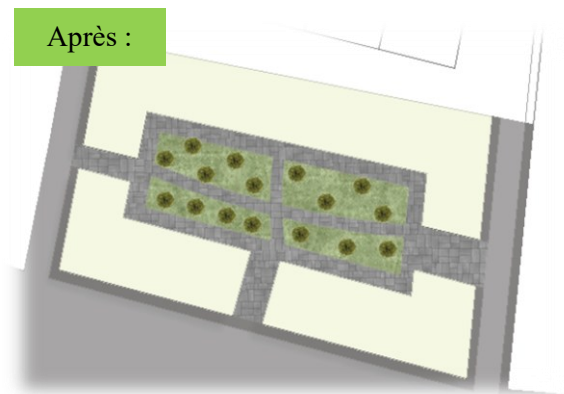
vue en plan de bâtiment Azlef après l'intervention.
